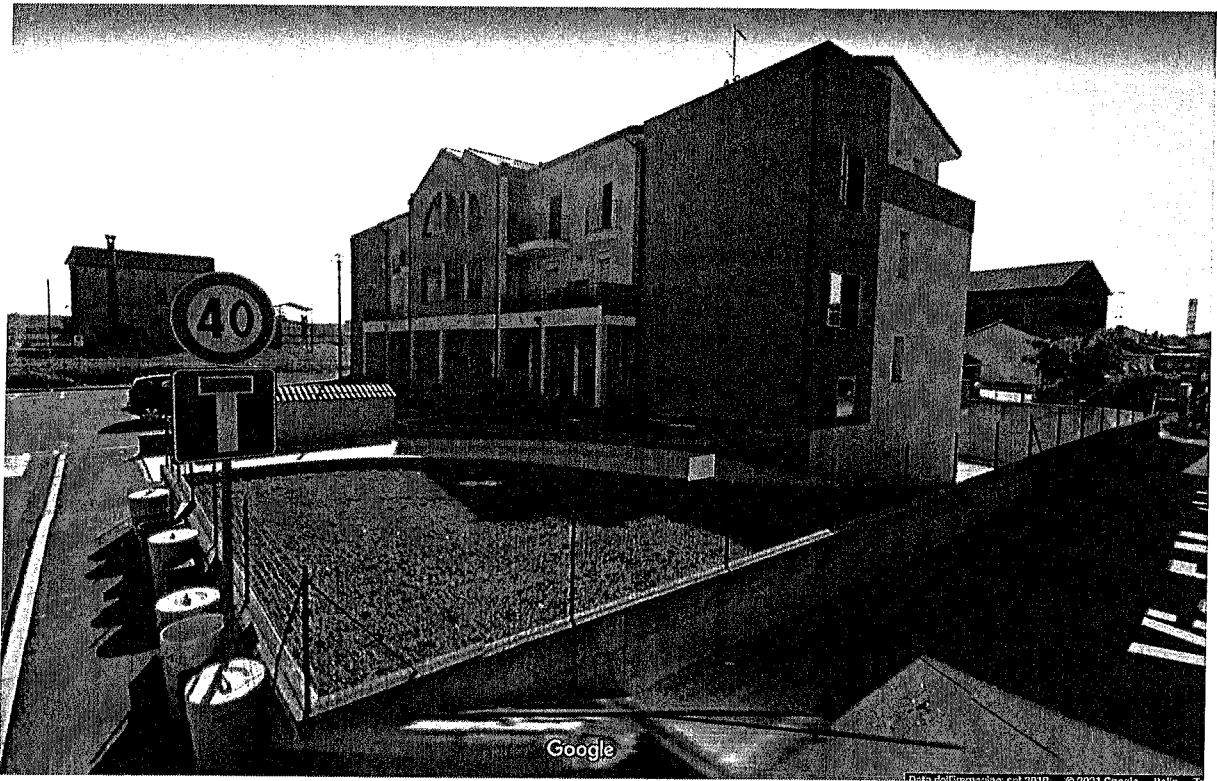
Vista generale Condominio Greval e rampa di accesso al piano interrato
